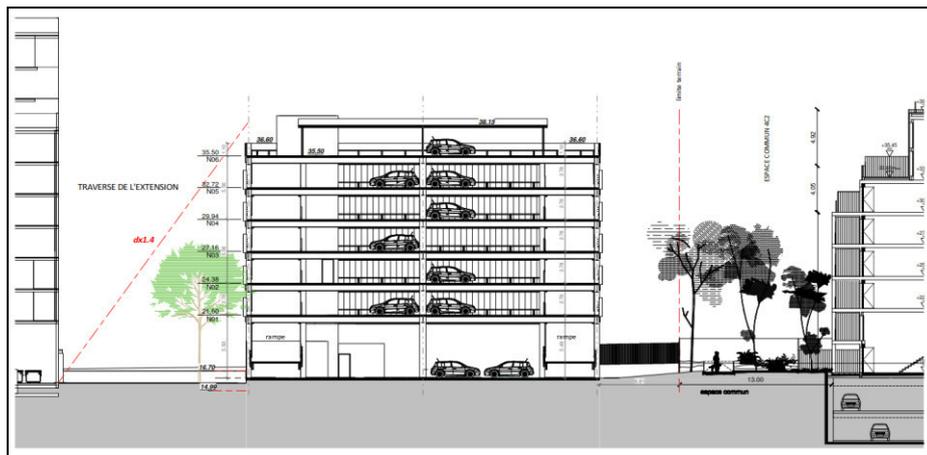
Coupe sur le parking silo (source : Linkcity, 2019)
